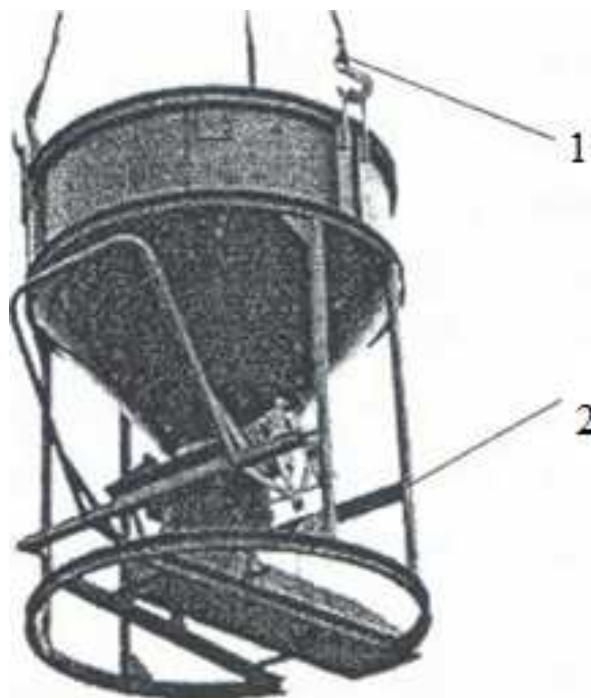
Схема строповки неповоротного бункера (бадьи) с бетонной смесью
